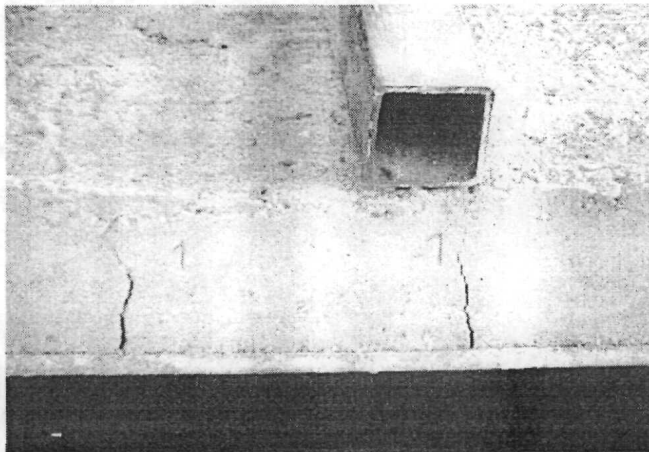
Grietas debido a los esfuerzos de corte y flexión
